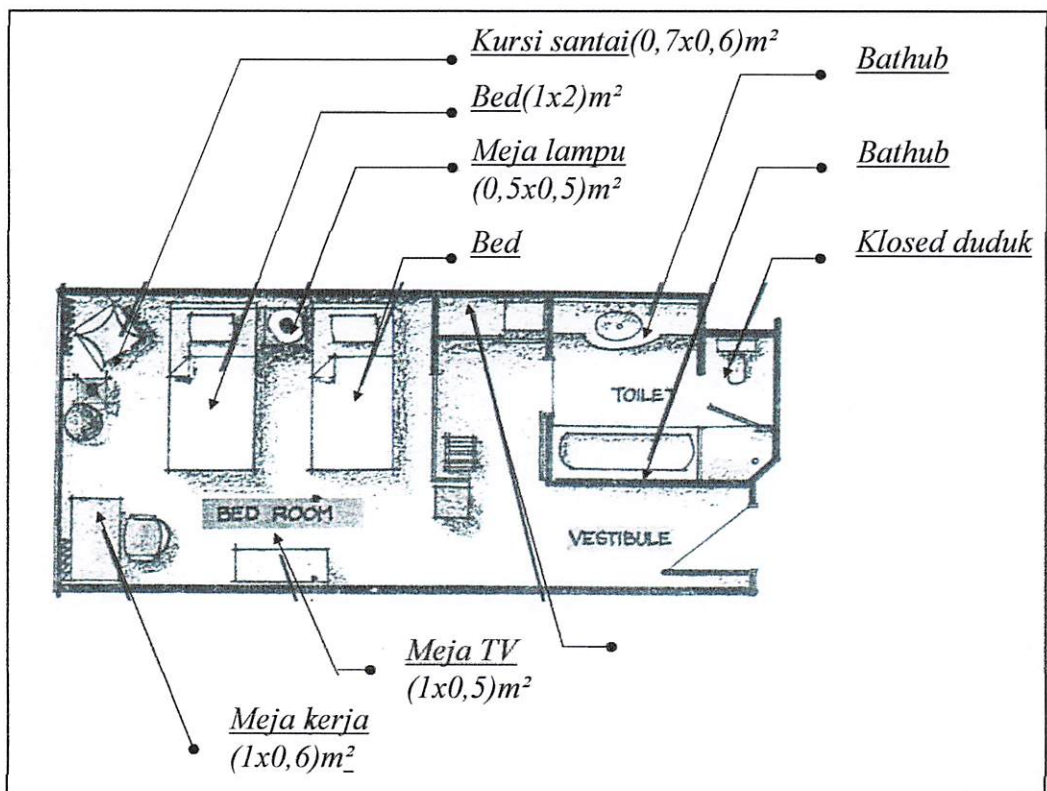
Standart Guest Room Tipe A dan Tipe B
